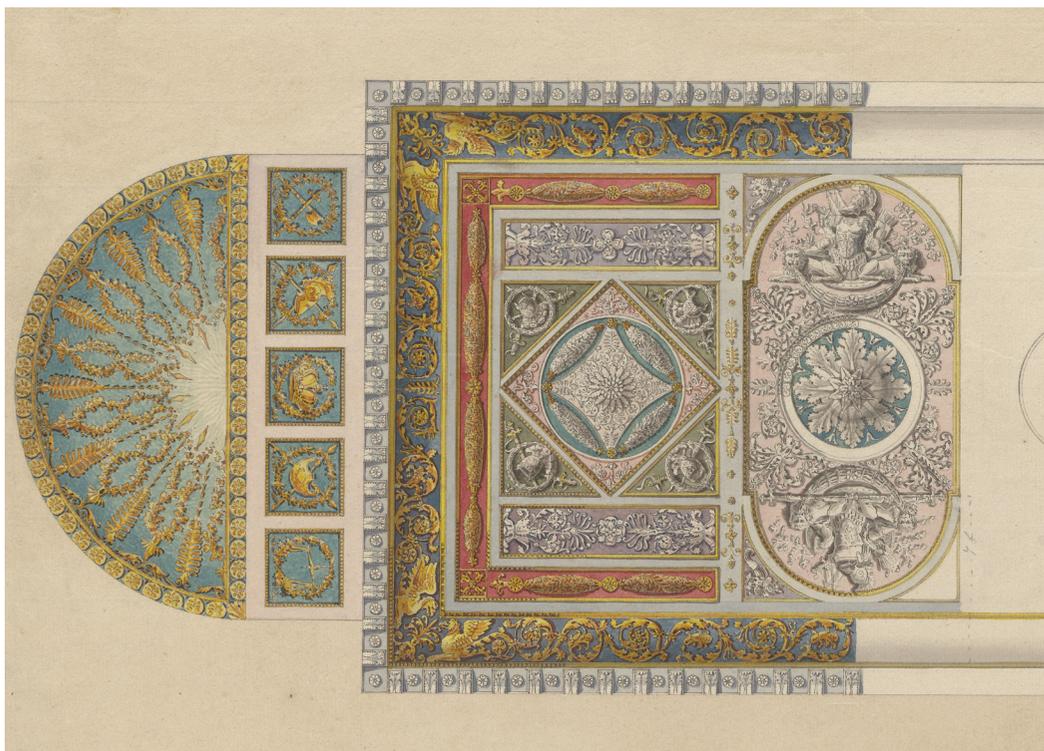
Johann Conrad Bromeis, *Residenzpalais Kassel, Aufriss der Decke im Coursaal*, um 1818, farbige Federzeichnung, 30 x 60 cm, Potsdam, Stiftung Preußische Schlösser und Gärten Berlin-Brandenburg, Plankammer, Residenzpalais, Mappe II
